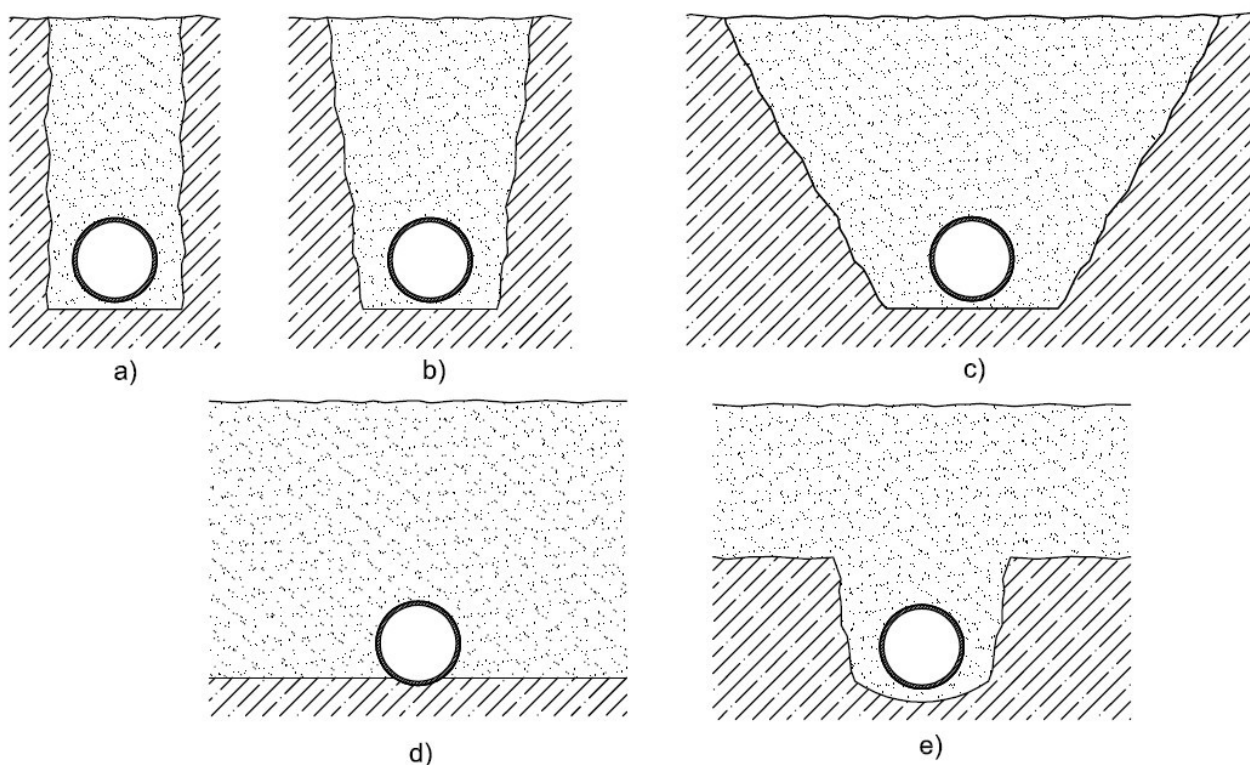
a) trincea stretta con pareti verticali; b) trincea stretta con pareti inclinate; c) trincea larga; d) trincea indefinita; e) trincea stretta con rinterro indefinito.
